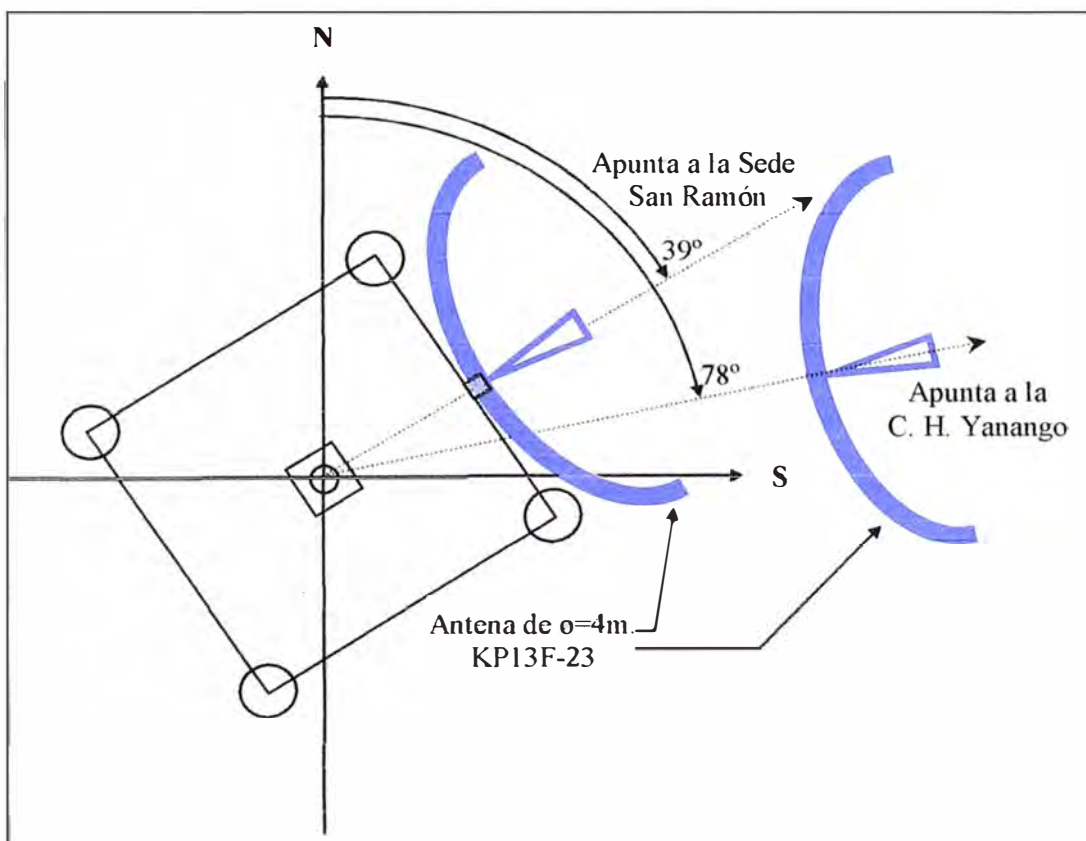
Vista de Planta de la Torre – Cerro Primavera
